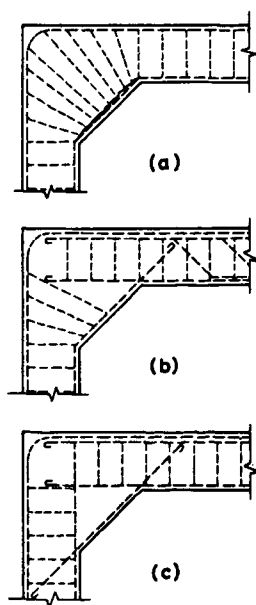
Detalle de esquina en un marco. En la Fig. a) se ha doblado la armadura defectuosamente. b) y c) serían las soluciones más recomendables.
